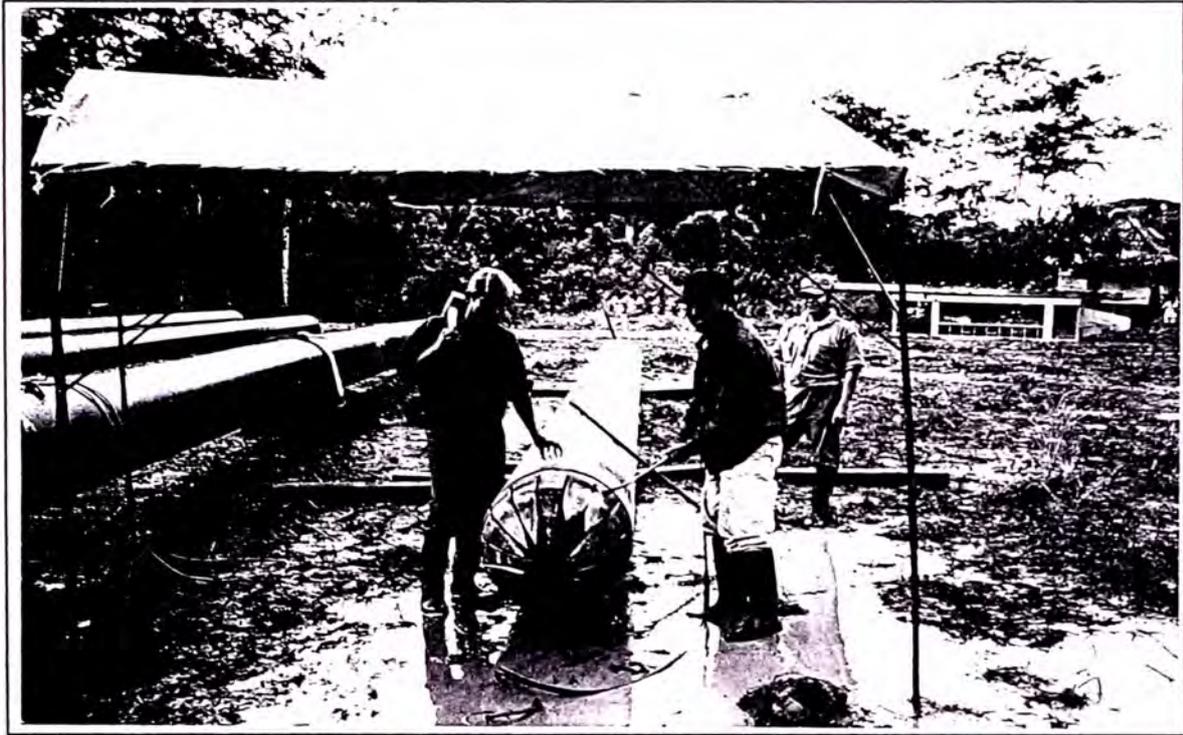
Seccionado de tubo para elaboración de Cabezal.
